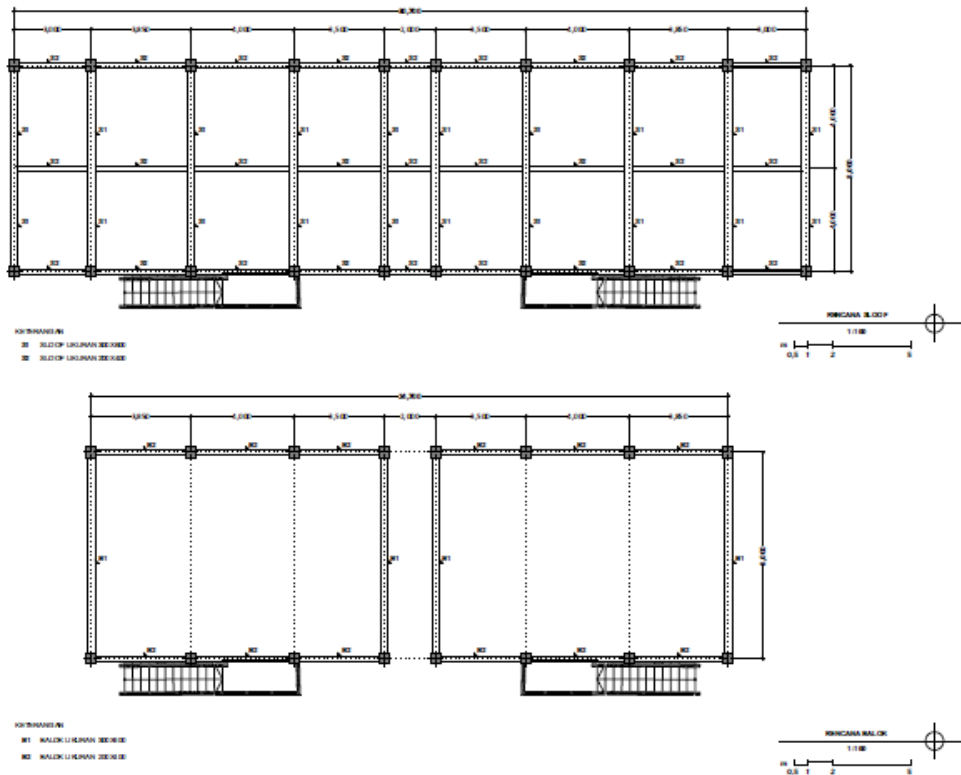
Rancangan Sistem Struktur Asrama Santriwan dengan Pondasi Footplate.
